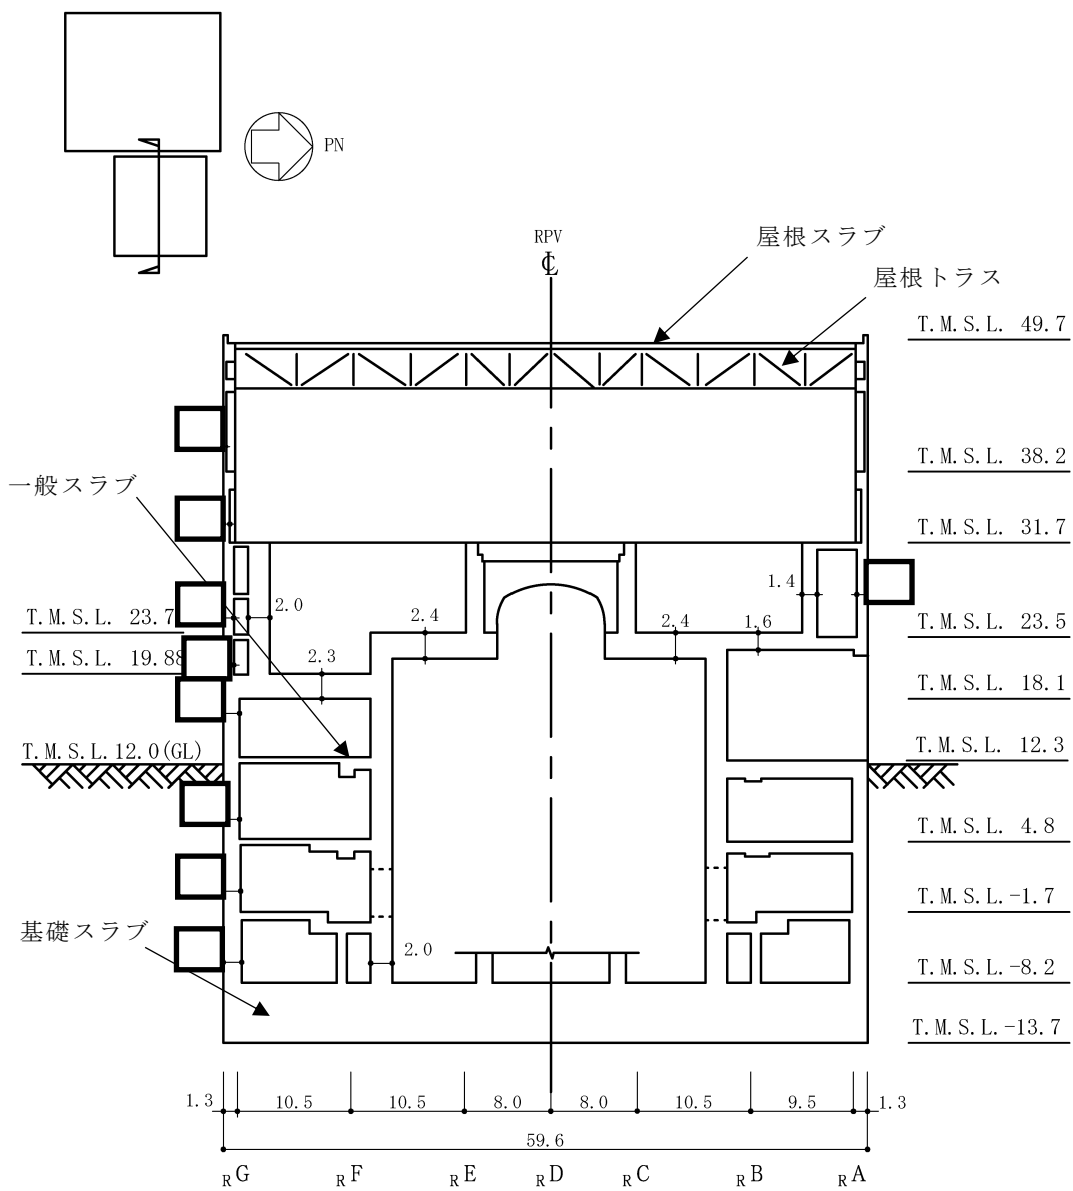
原子炉建屋の概略断面図 (EW方向) (単位 : m) (2/2)
